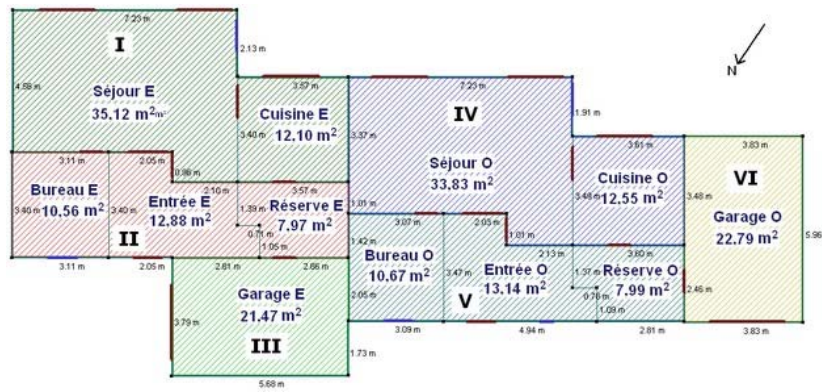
Plan du rez-de-chaussée du bâtiment modélisé et découpé en zones thermiques
